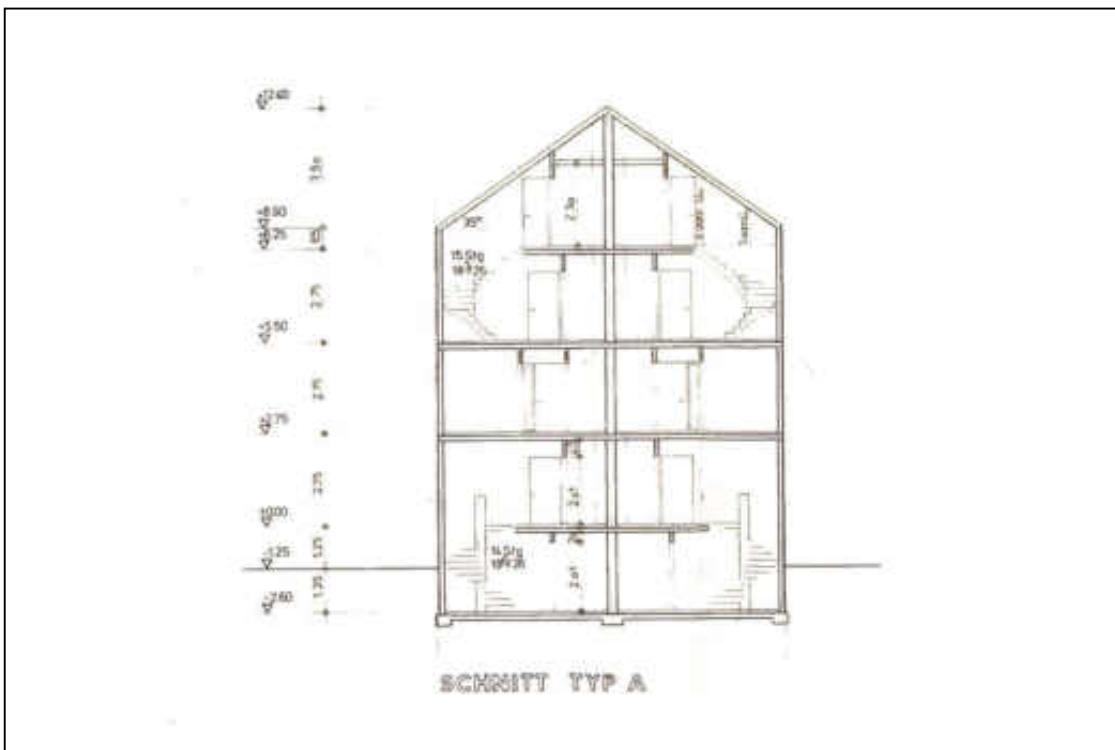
Schnitt durch das Gebäude vom Gebäudetyp A
